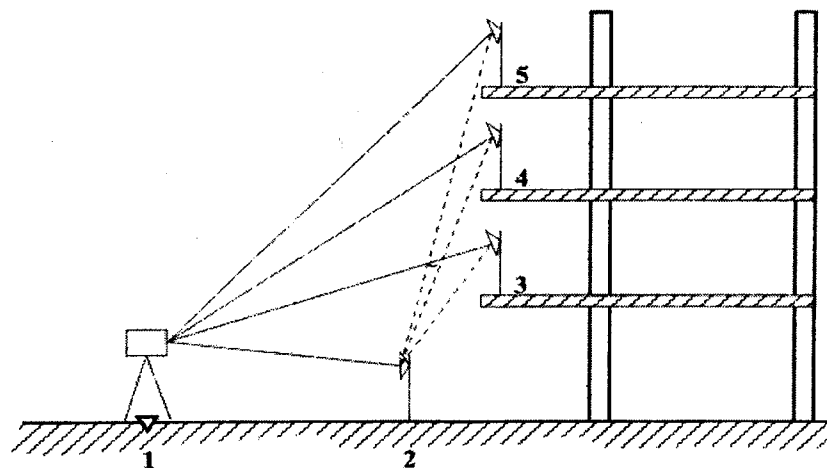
Передача оси и отметок на верхние этажи здания
